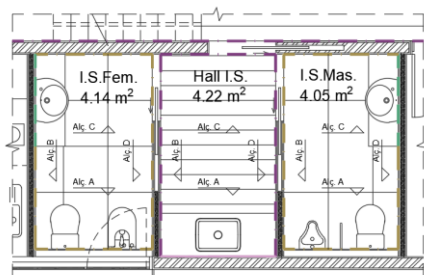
Demonstração de planta de pavimentos e acabamentos. Fonte: Autora.
